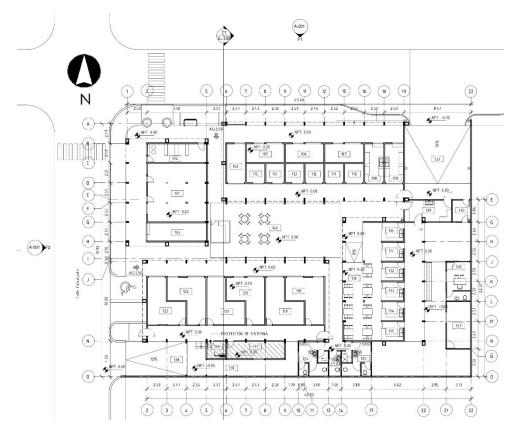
Planta Arquitectónica de Mercado Municipal
